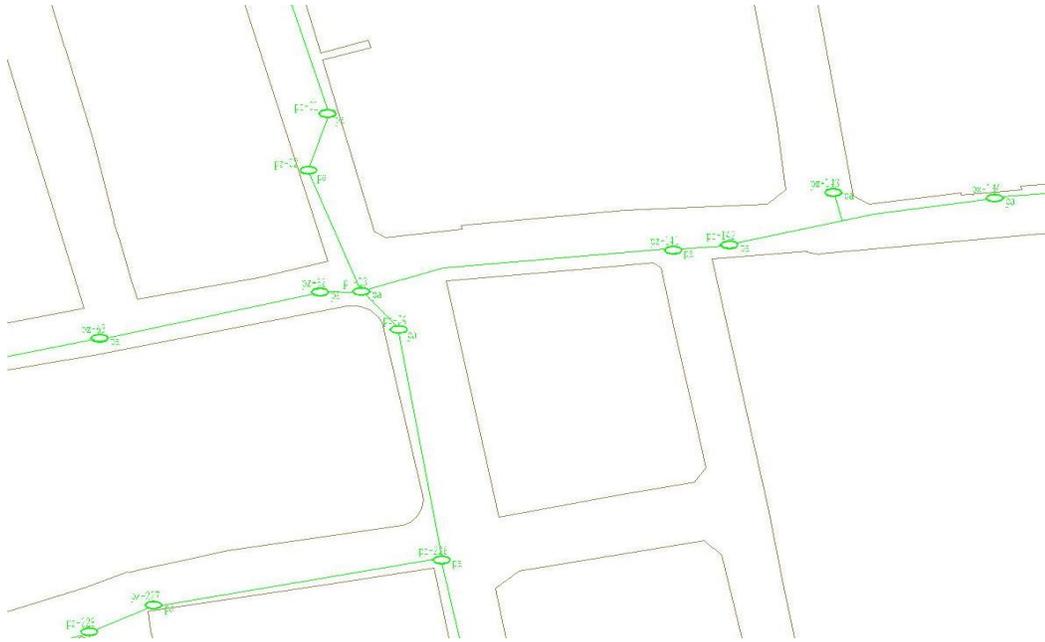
1 Levantamiento de la canalización existente. [Fuente: Los Autores]
